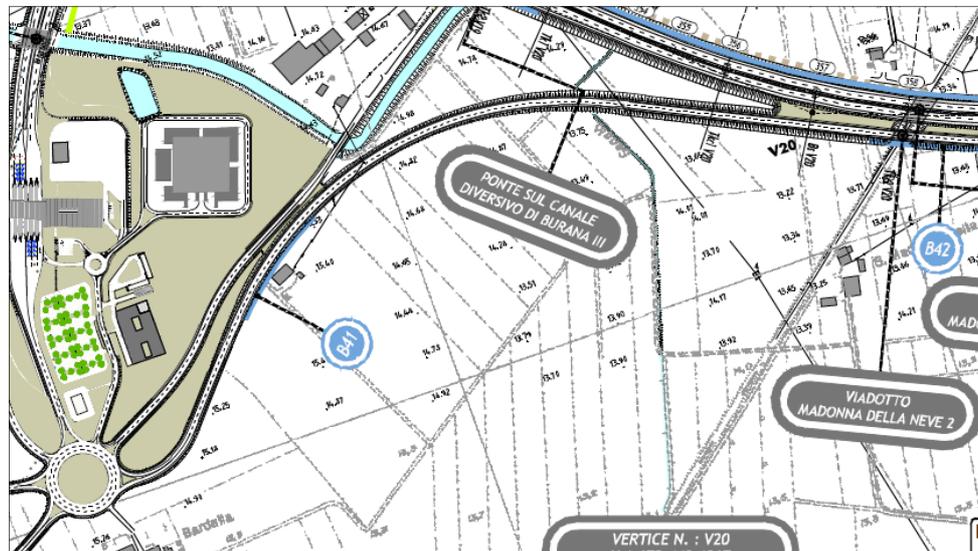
TRACCIATO INTERESSATO DA MODIFICA COME DA PP (STRALCIO DA 1:5000)
